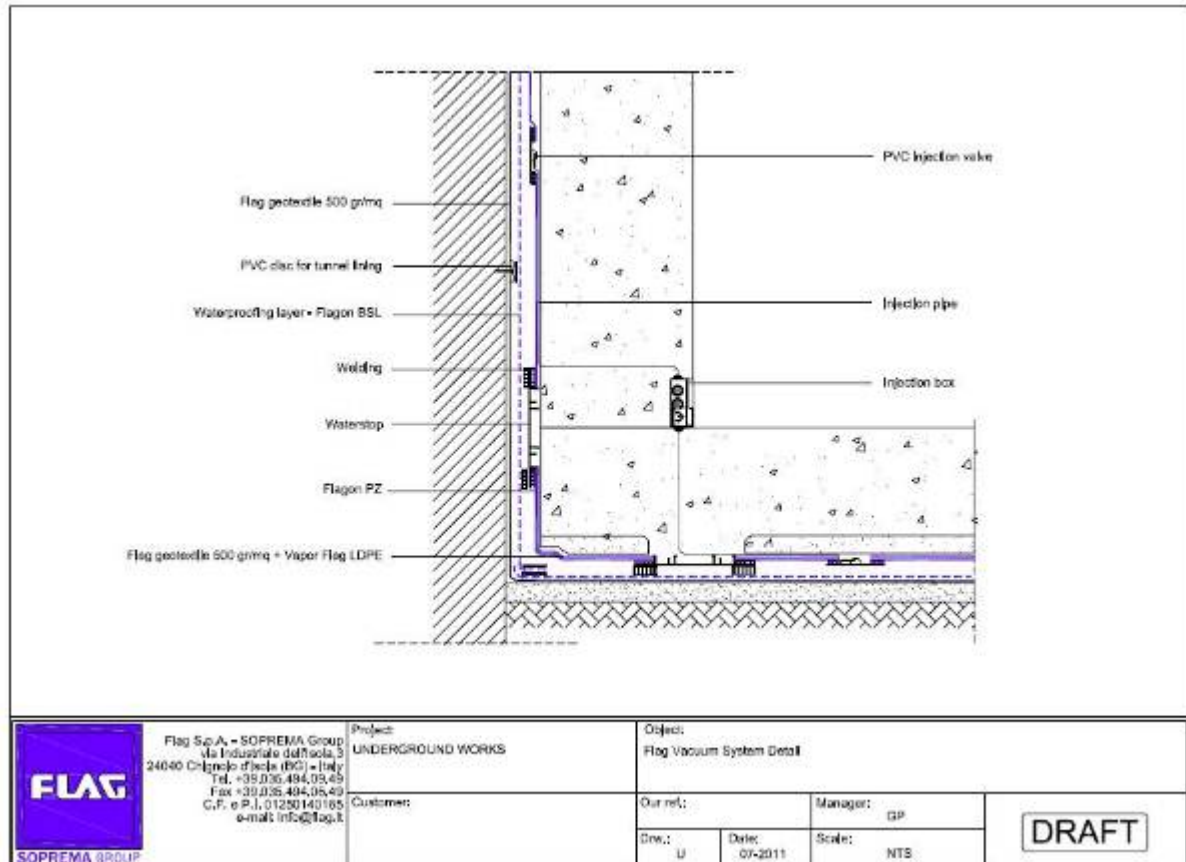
Detalhes do sistema de impermeabilização "Vácuo".
